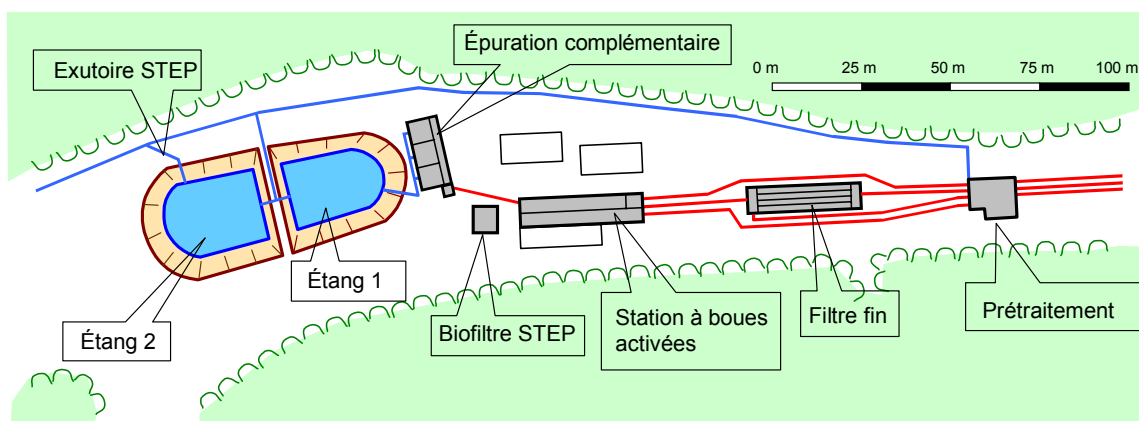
Vue d'ensemble des installations de la STEP de la DIB.
